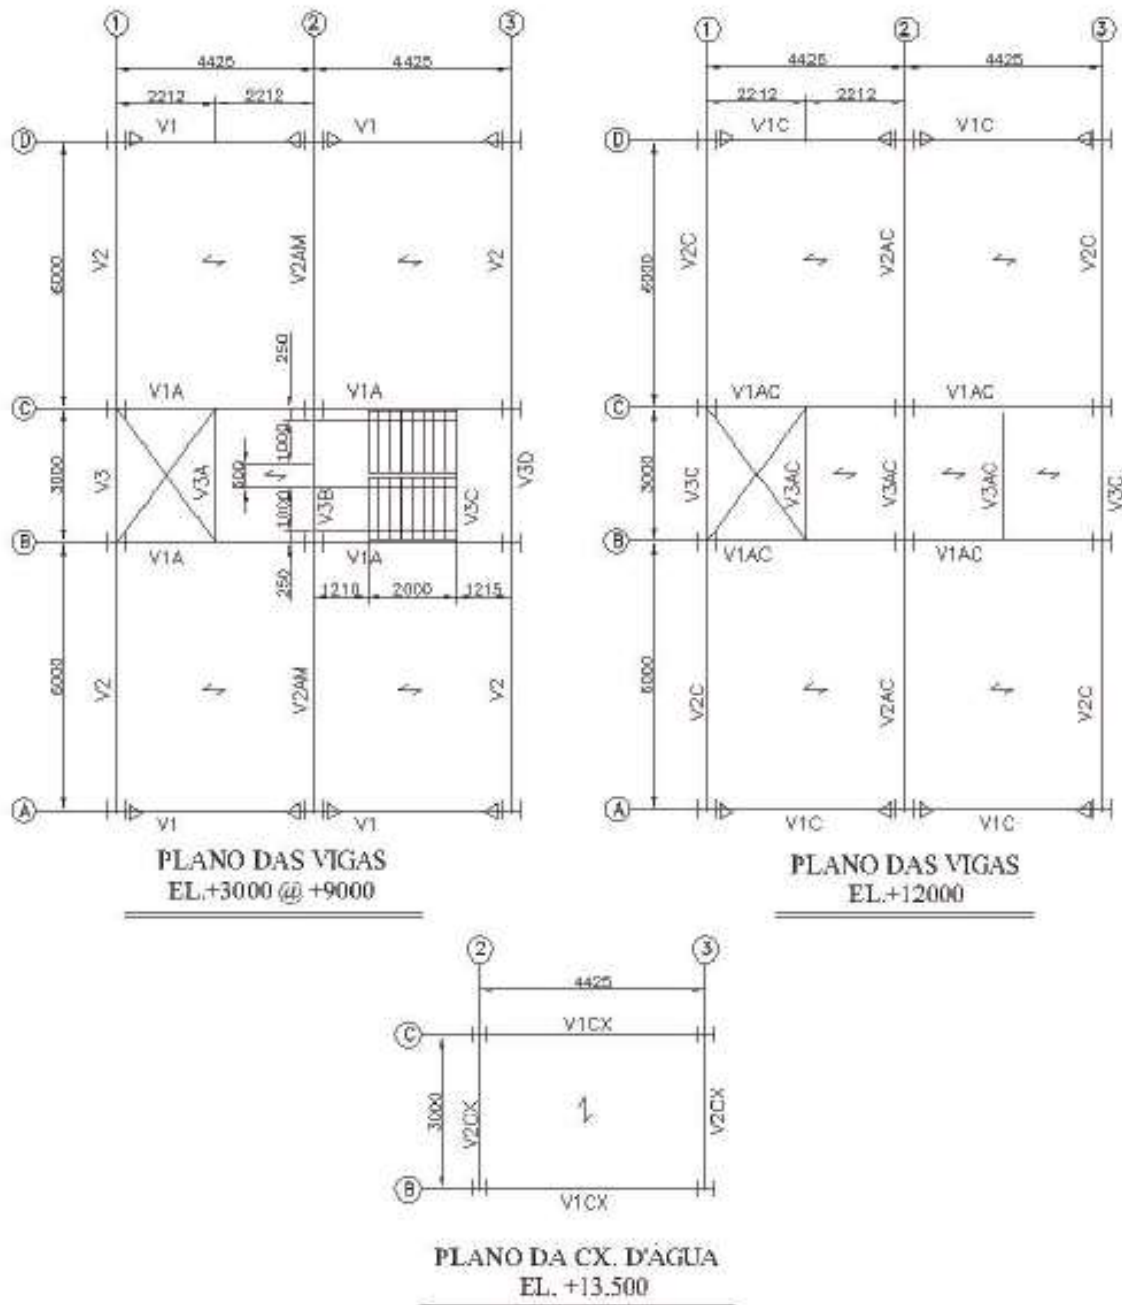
Planta de plano das vigas. Fonte: INSTITUTO AÇO BRASIL et al., 2011.
